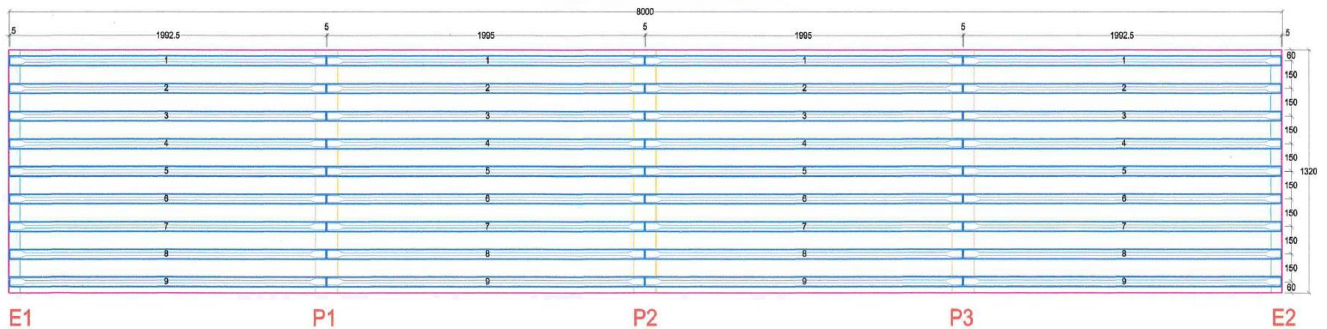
VISTA EN PLANTA DEL PUENTE
